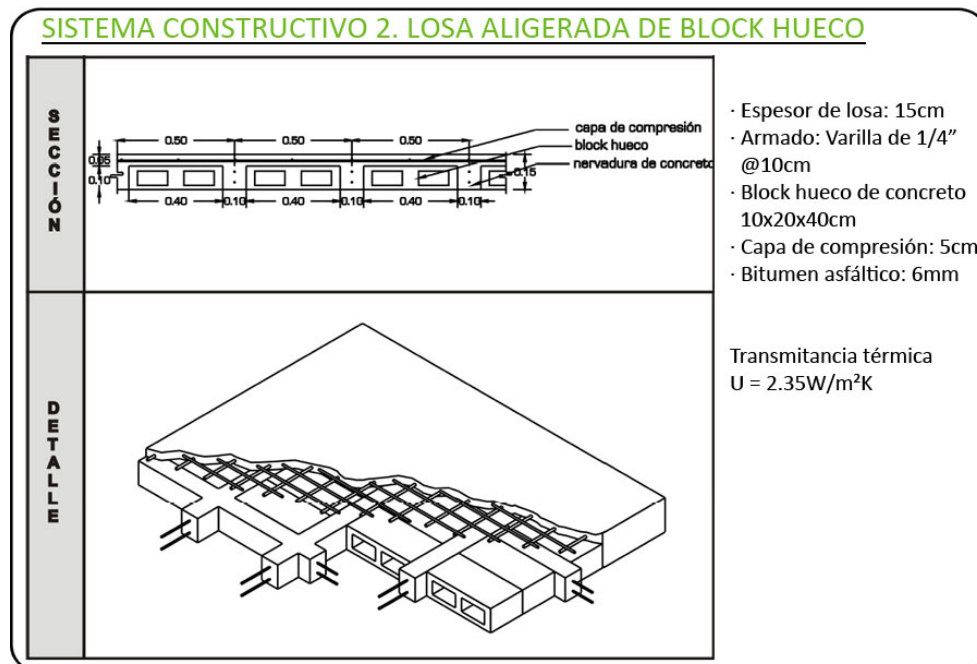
Sistema constructivo para la cubierta de la vivienda de interés social en México.
